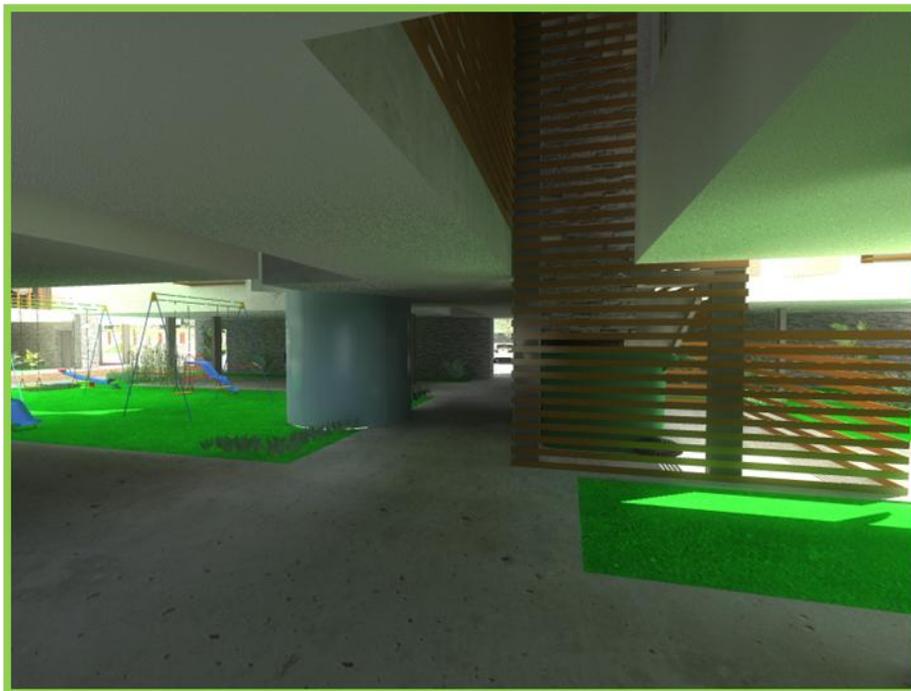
Vivienda vertical. Planta baja, área de juegos infantiles y cubo de escaleras. Fuente, archivo personal.
